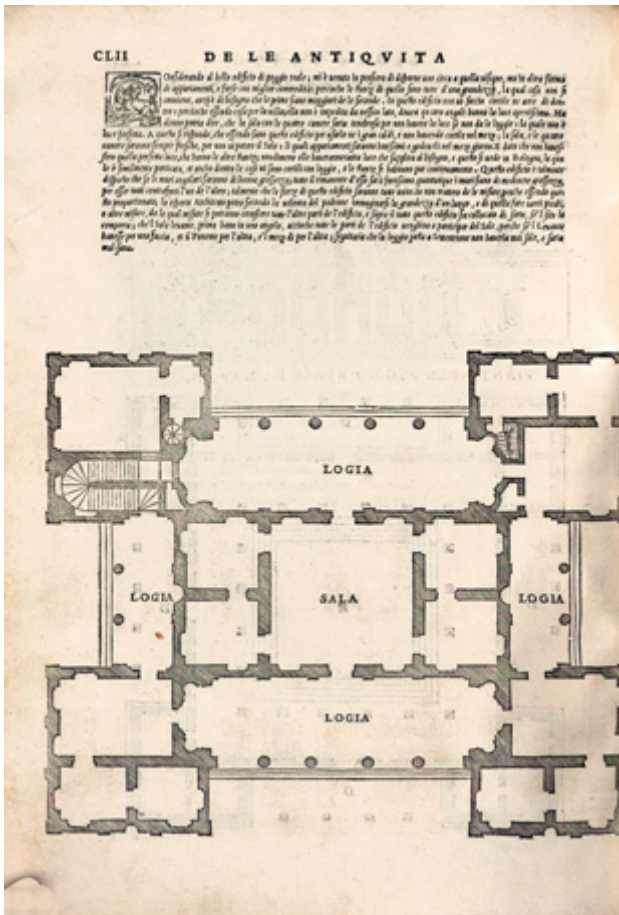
Neapel, Villa Poggio Reale. Grundriss der hoflosen Variante (nach SERLIO 1540).
